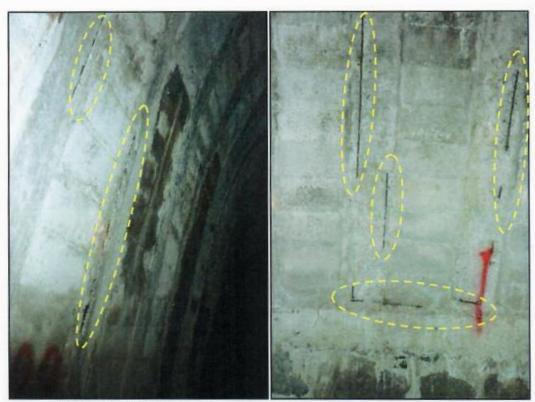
Acero de refuerzo expuesto en viguetas e infiltraciones (0+070 - 0+090).
